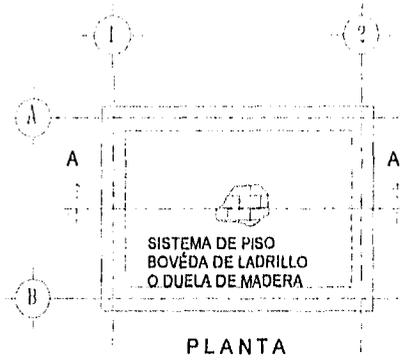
III PRIMER TIPO DE ESTRUCTURACIÓN.
